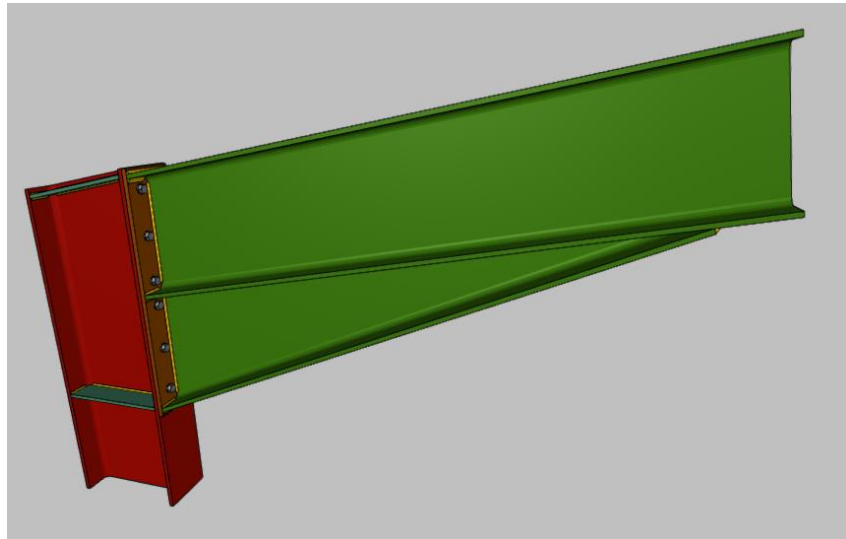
Detalle unión pilar-viga atornillada [7].
